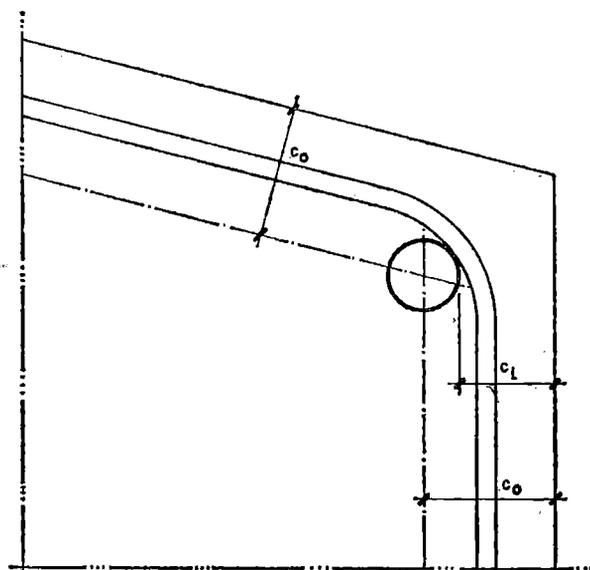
RECUBRIMIENTO c_1 DE LA ARMADURA LONGITUDINAL Y DISTANCIA c_0 DEL CENTRO DE LA ARMADURA AL PARAMENTO MAS PROXIMO.
